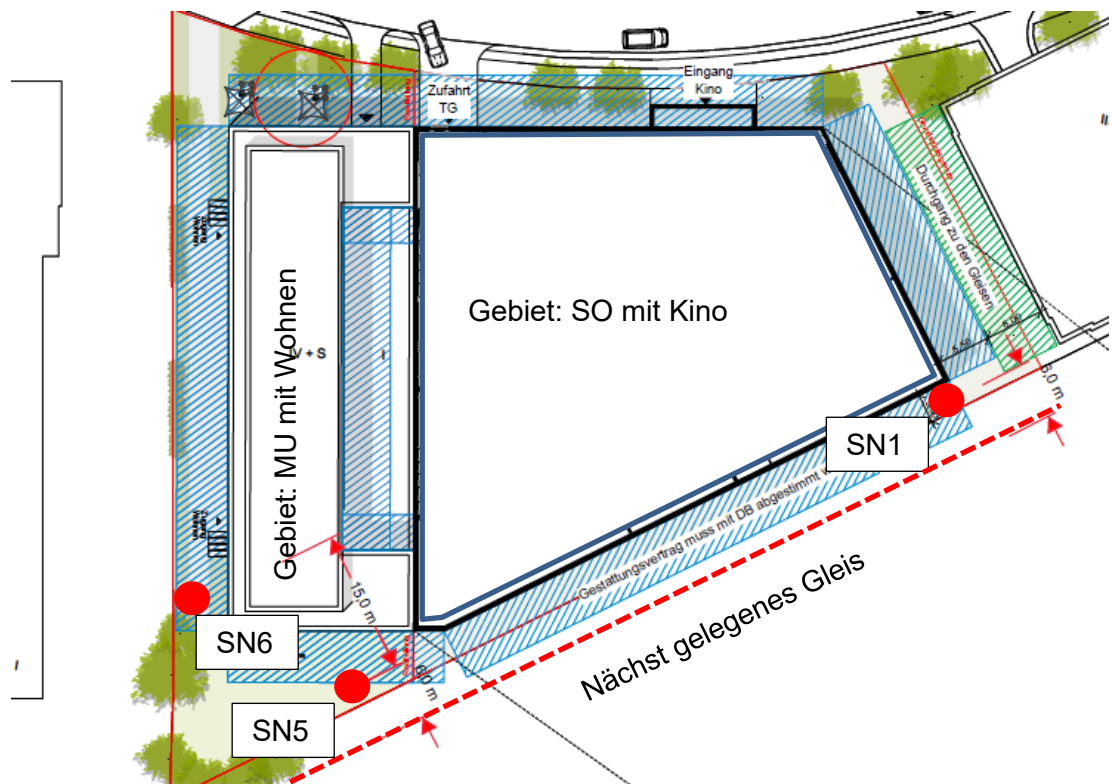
Lageplan mit Grundriss des geplanten Gebäudes sowie maßgebende Messpunkte SN1 und SN5.
